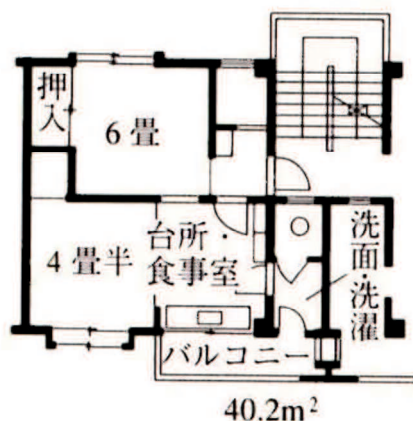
公営住宅標準設計 51C 型の住戸平面図
